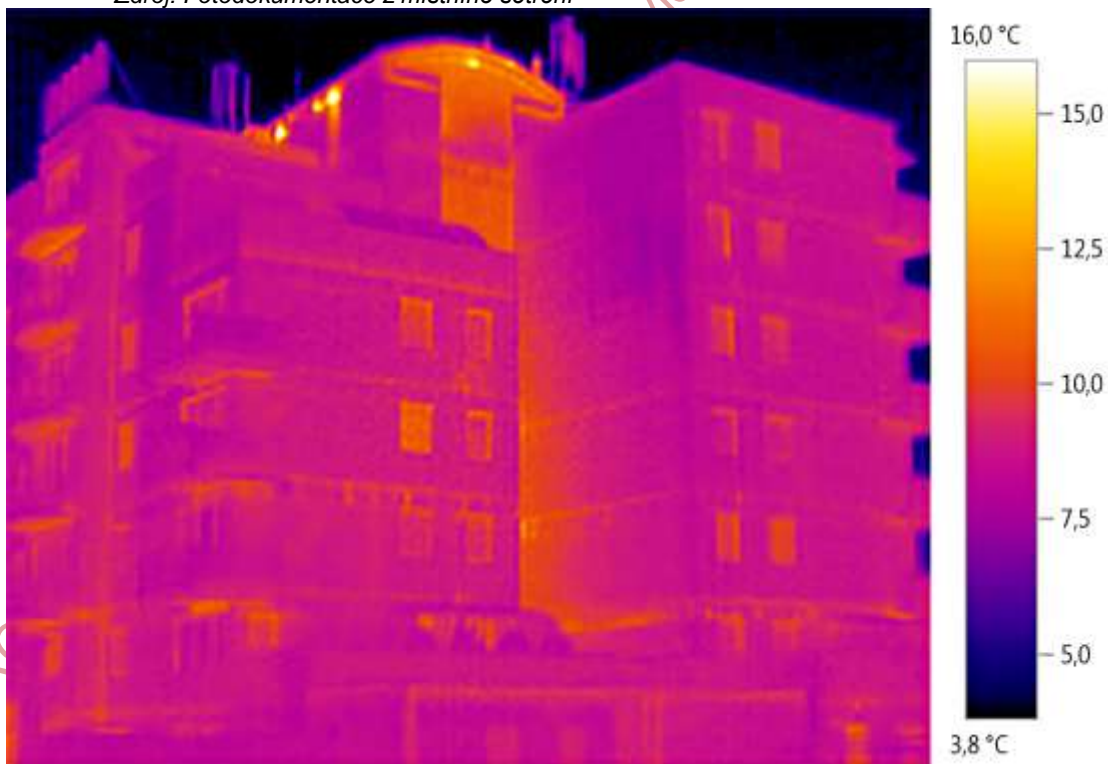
Severní fasáda. Termovizní snímek dokumentující zvýšenou povrchovou teplotu fasády v místech železobetonových stropních ztužidel, sloupů skeletu, ale i vykrakorcovaných balkónů
